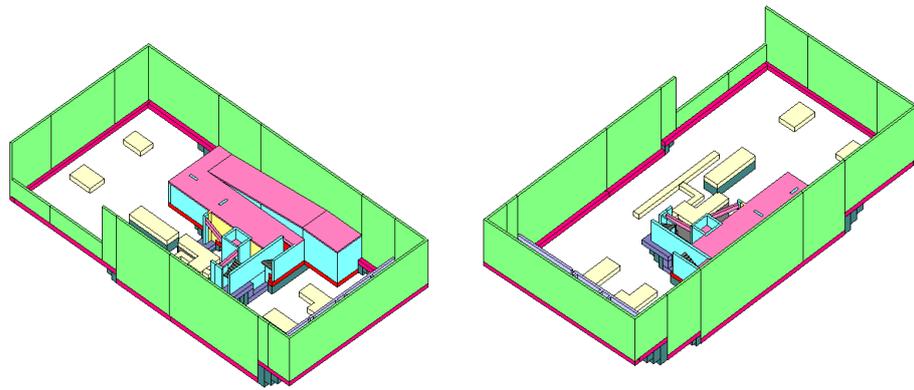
Vista Laterales en 3D del proyecto, usando BIM
